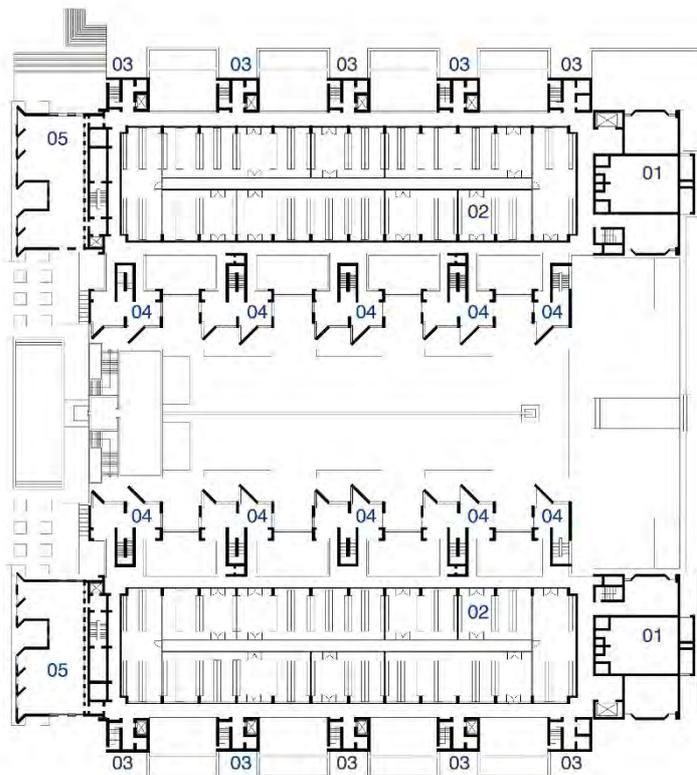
| Planta nível +2 (LABORATÓRIOS E ARCADA) [redesenho do autor]
